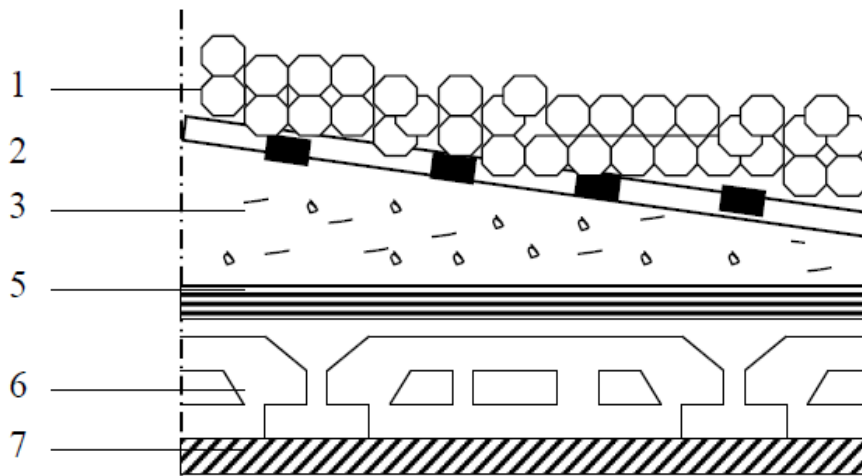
Coupe verticale du plancher terrasse inaccessible.
